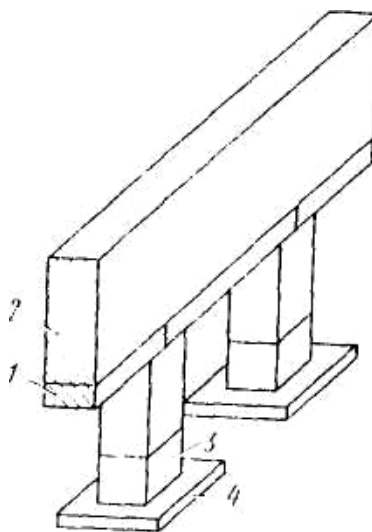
Отдельные (столбчатые) фундаменты под стены бескаркасных зданий:
